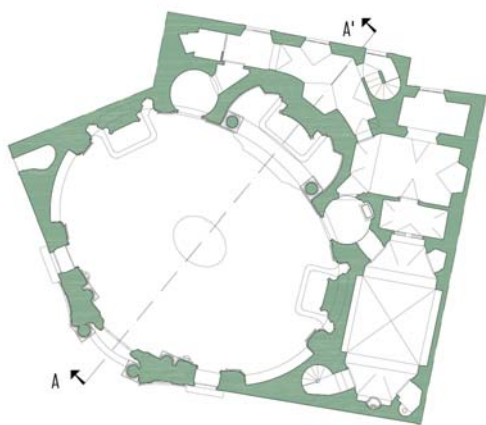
Planimetria della Chiesa di Santa Caterina a Lucca. Piano terreno
